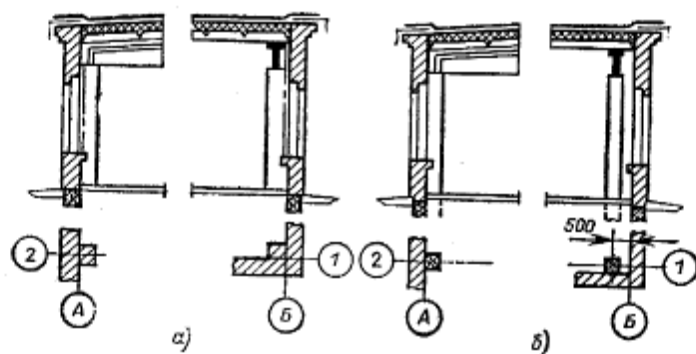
Привязка элементов здания к разбивочным осям бескрановых зданий: а – несущие стены с тяжестрами, нулевая привязка внутренней грани стены; б – нулевая привязка со смещением осей торцевых ферм на 500 мм.
